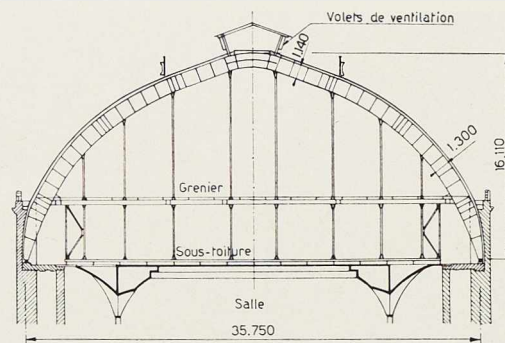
Coupe transversale montrant la charpente métallique de la toiture. Noter le tirant placé au niveau du plancher du grenier.
